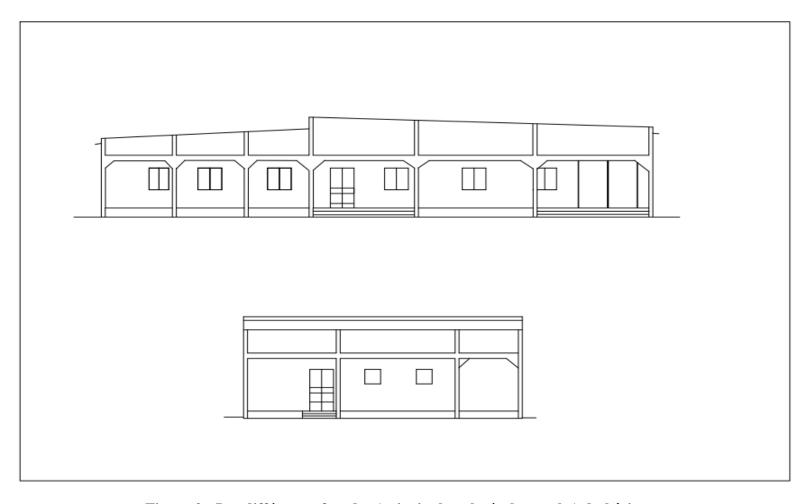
Les différentes façades (principale et latérale gauche) du bâtiment
